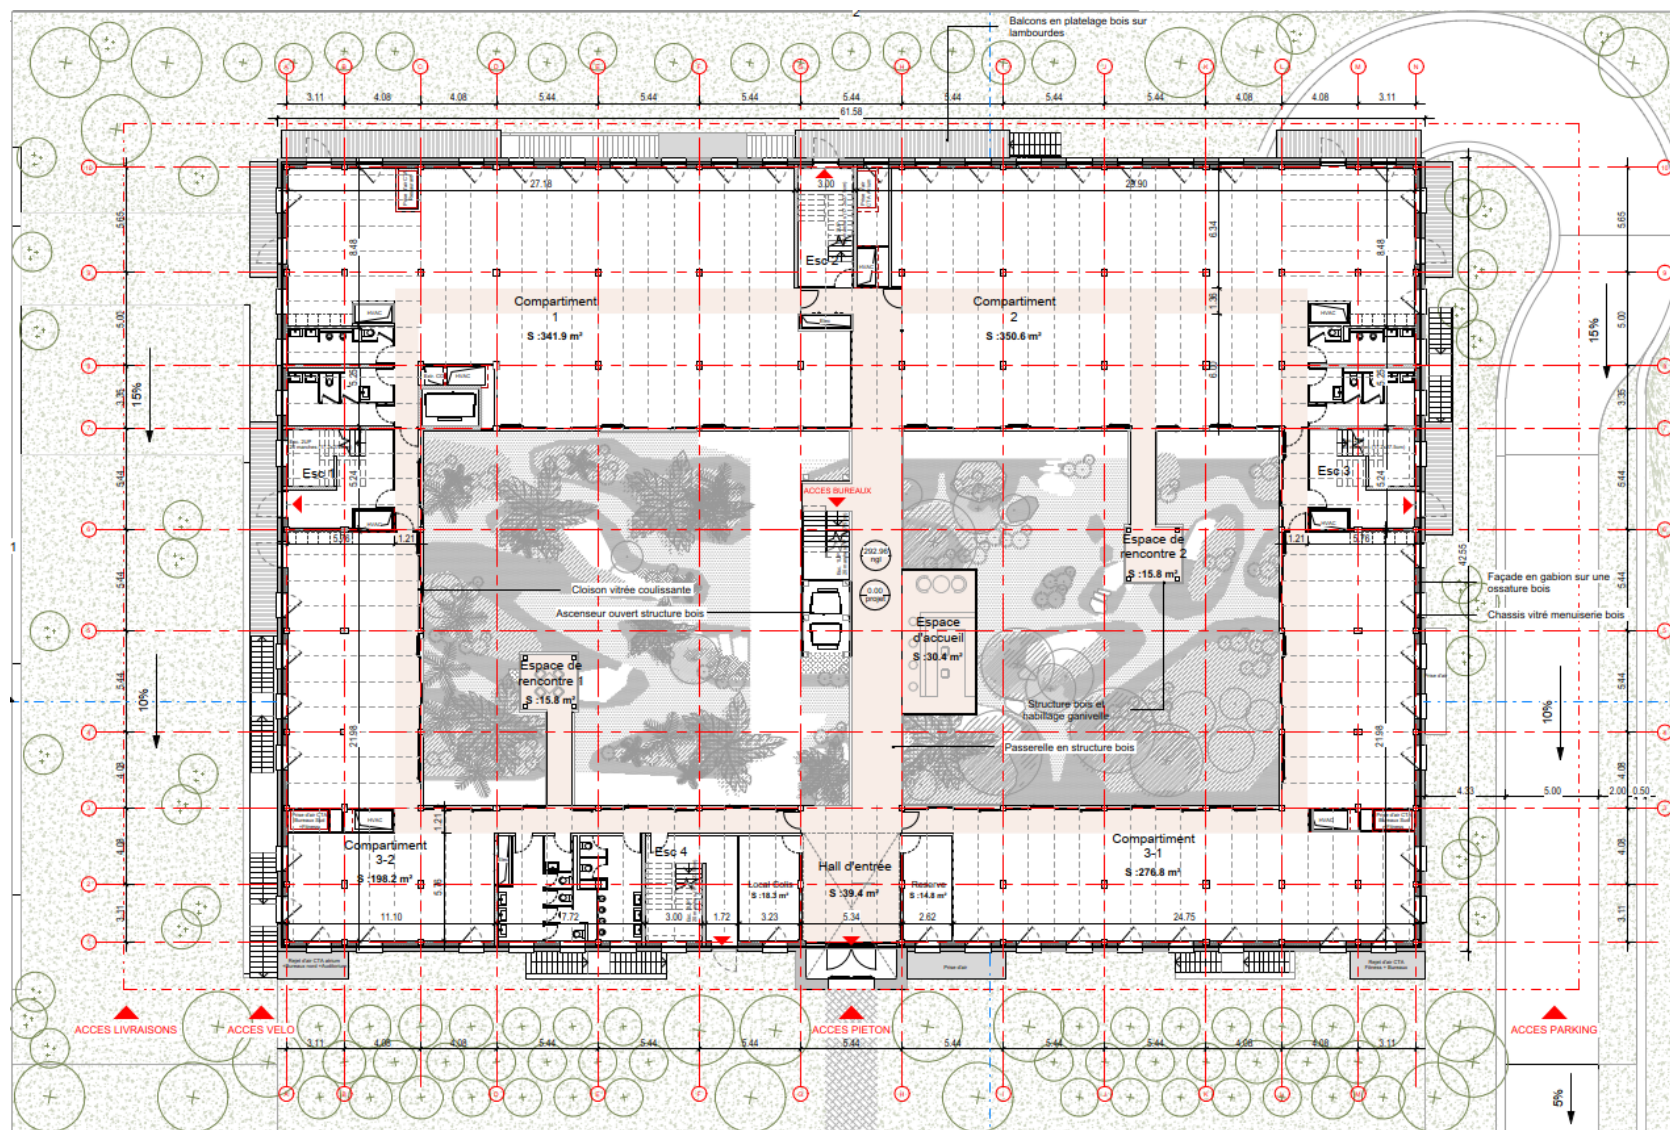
Plan du RDC mit Gebäude und unversiegelten Bereichen sowie Zufahrtsbereich zur Tiefgarage (Maison Edouard François 01/2023). Größere Darstellung in Anhang 04 Seite 5
